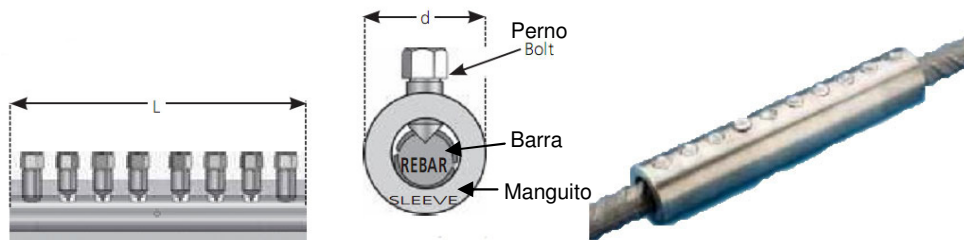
Conector con tornillos bloqueantes (izquierda), con tornillo bloqueante cortado (derecha).
